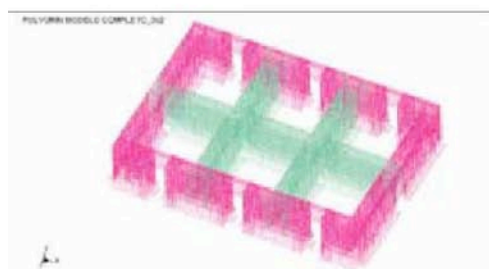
Armaduras Ø25 mm de muros interiores y muros perimetrales
